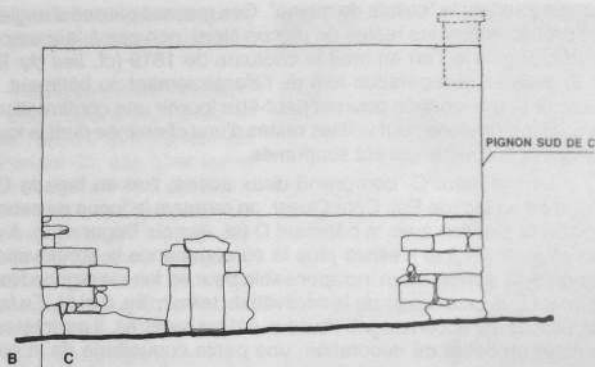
Bâtiment C avant la construction du D. Façade Ouest.
